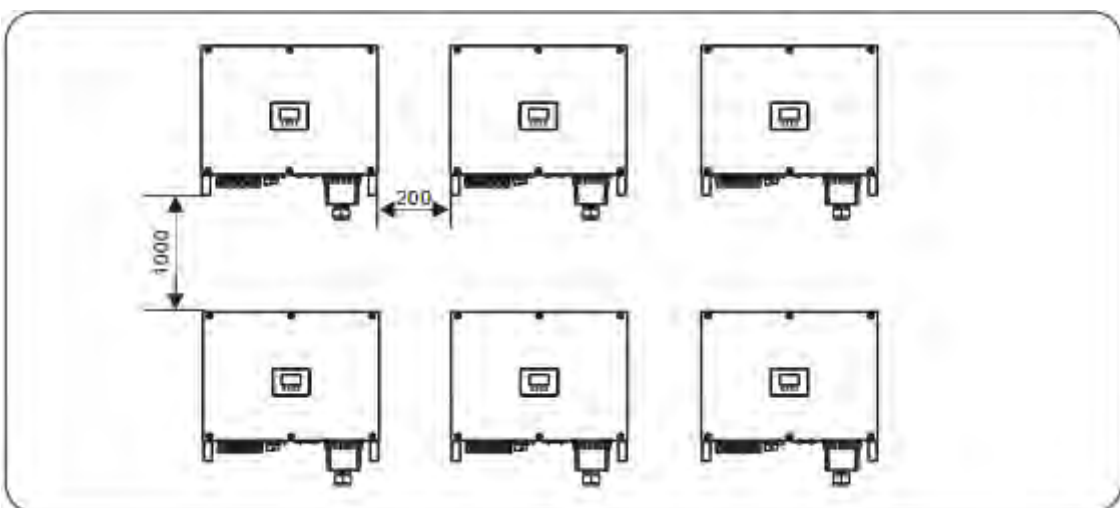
Installazione in modalità sovrapposta (unità: mm)
